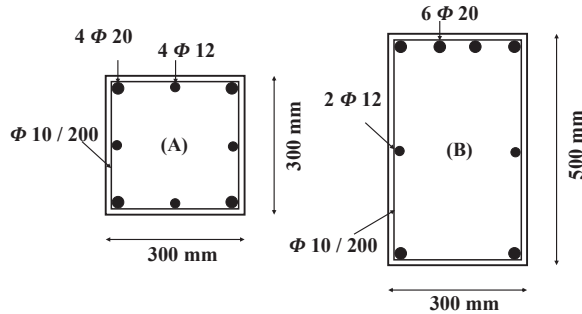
Querschnitte und Bewehrung von Stützen (A) und Balken (B) des untersuchten Stahlbetonskelettbau
